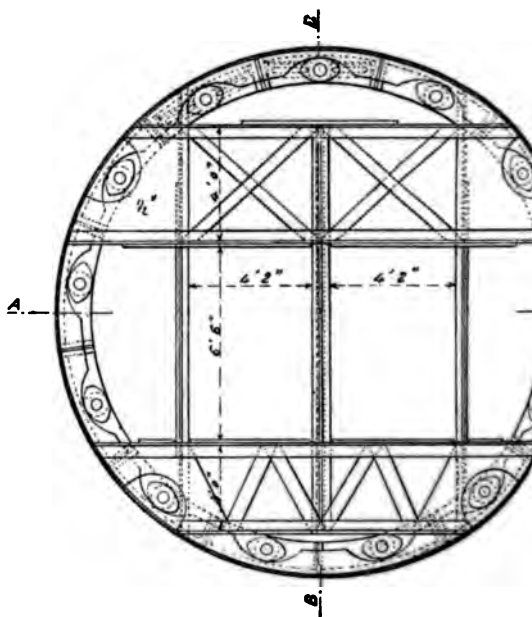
Deuxième bouclier. — Elévation arrière.
